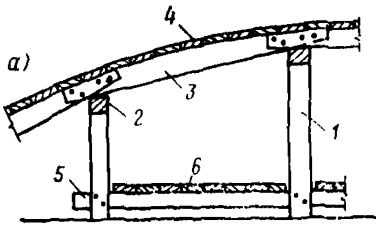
Двусторонняя опалубка наклонной железобетонной плиты перекрытия
